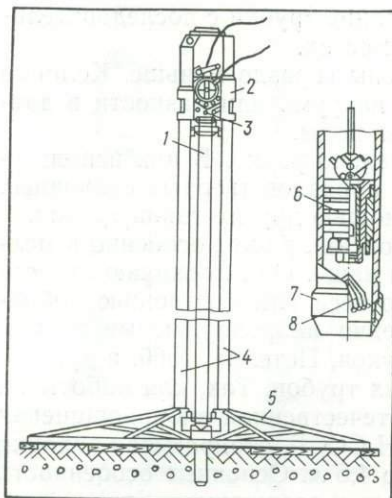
Схема устройства вибропоршневой трубки ВПГТ-60:
